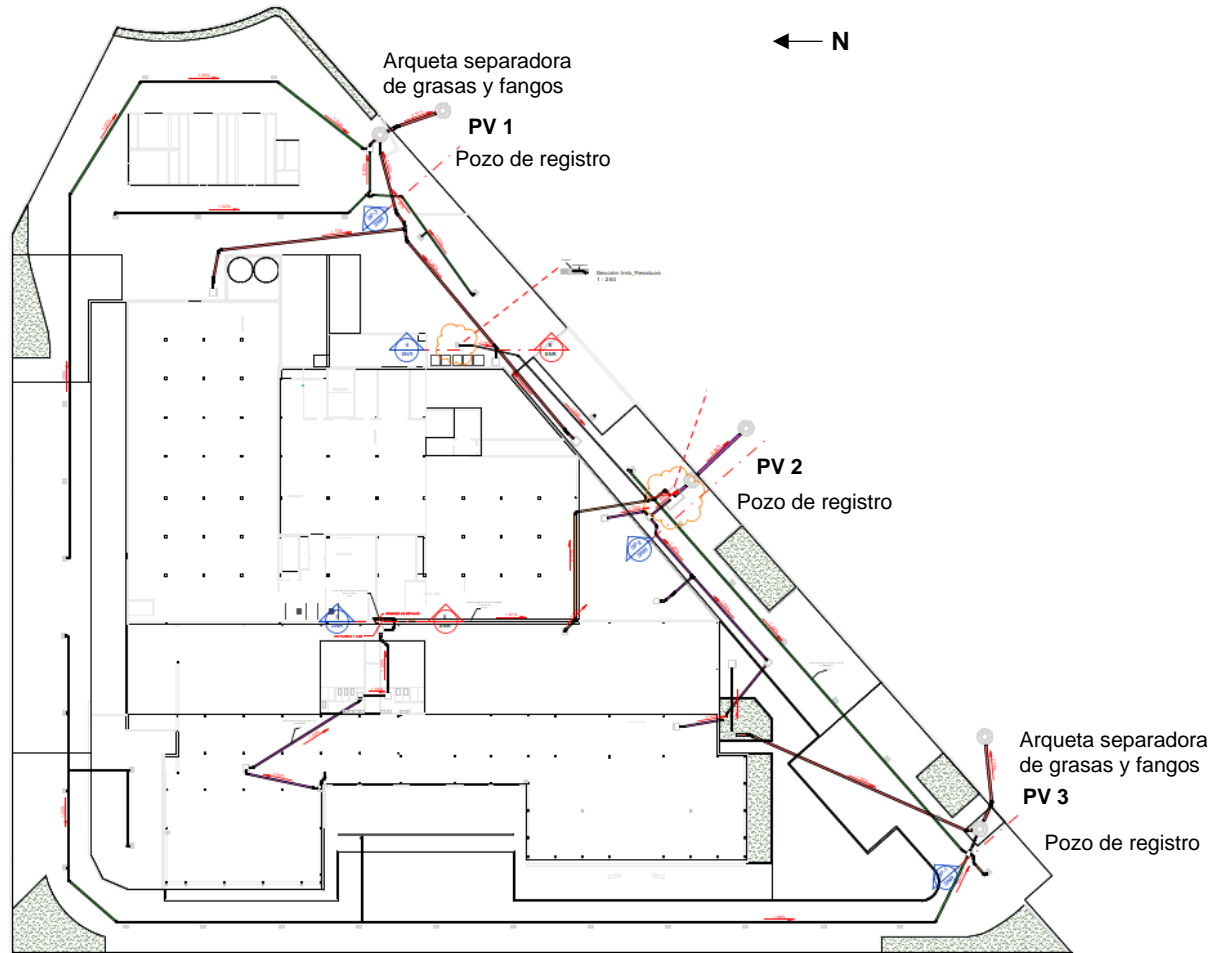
Red de saneamiento en la planta baja de la planta farmacéutica
